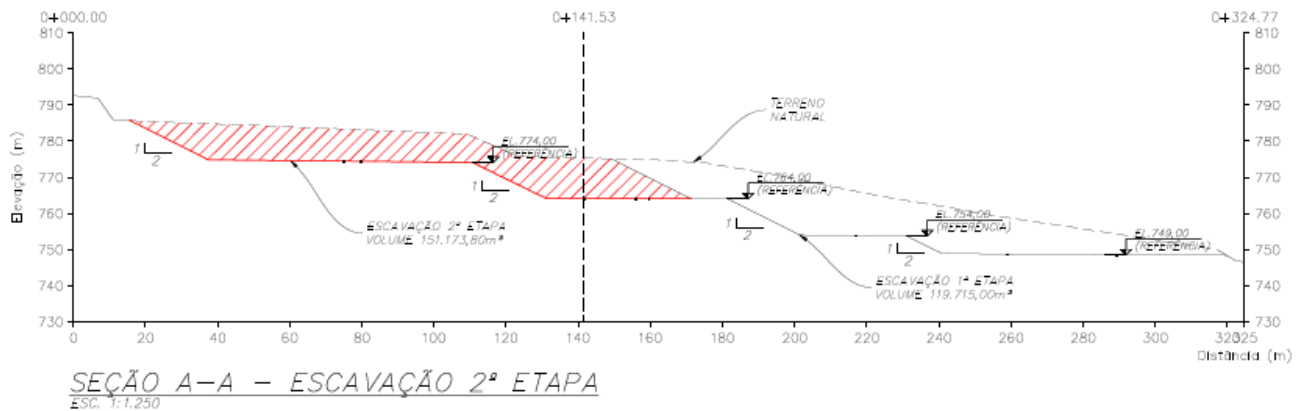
Seção mostrando a conformação dos cortes necessários à implantação do novo aterro sanitário de Viçosa, conforme projeto.
